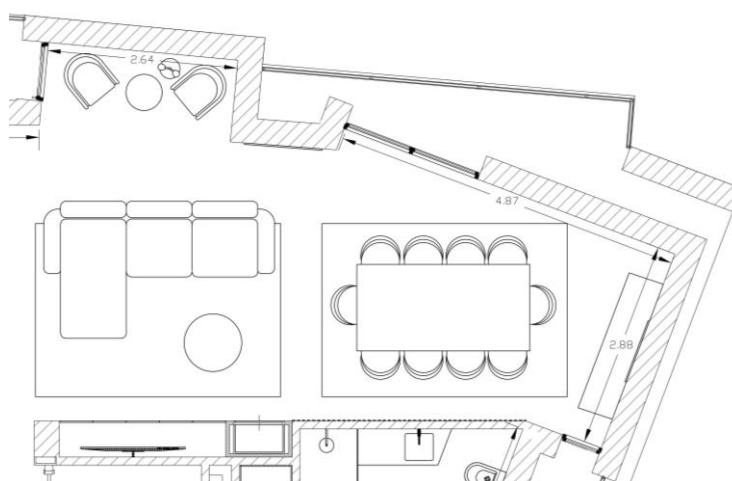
Pormenor Planta Sala de Estar | Jantar | Zona Lounge. Fonte: autora
